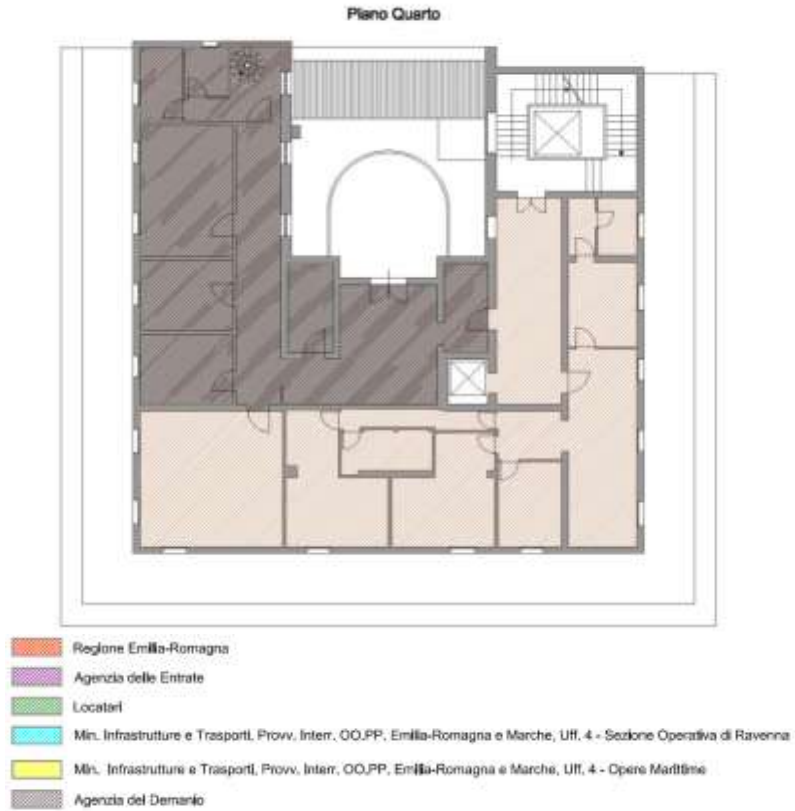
Pianta degli spazi occupati: piano quarto.
